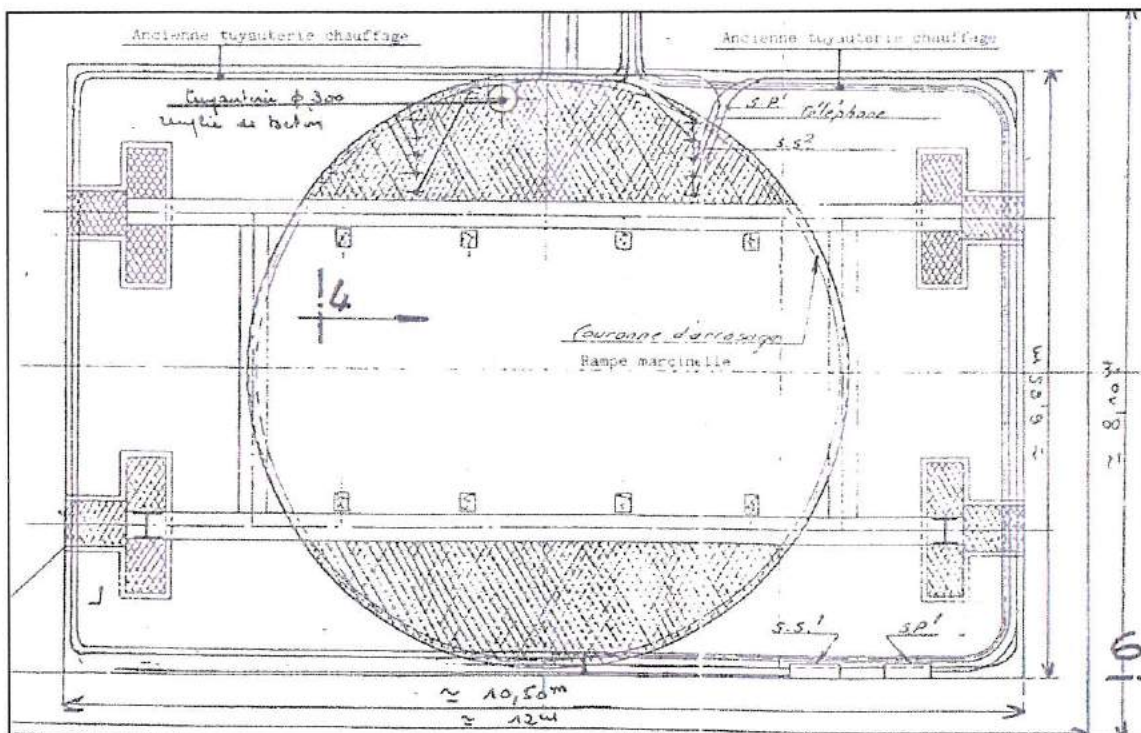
Plan des fondations au niveau du puits 19 (source BRGM-DPSM)
